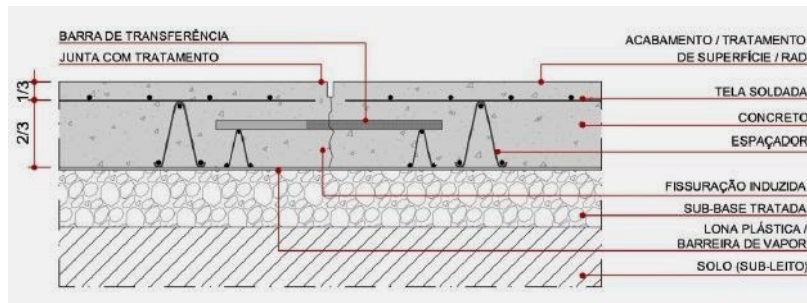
Seção de pavimento de concreto com armadura distribuída descontínua
